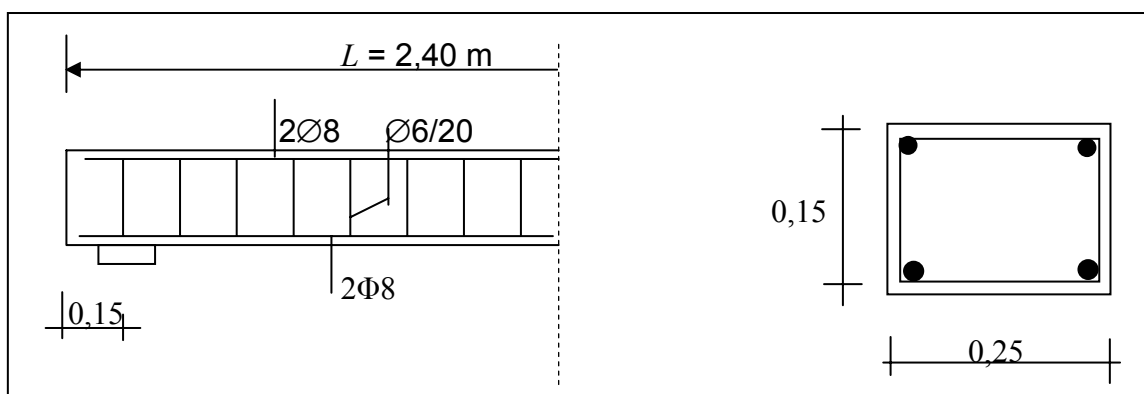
Querschnitt und Bewehrung [12, 13]
